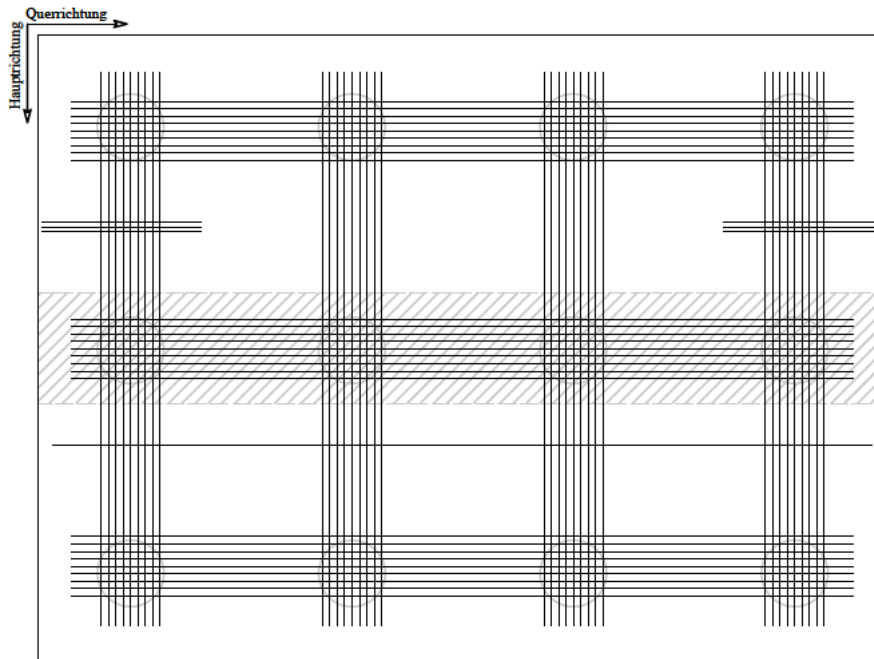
Variante 4 Lastfall 2 - Bewehrung unten
